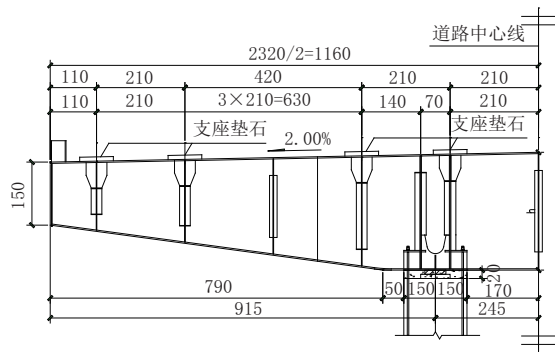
钢与混凝土复合结构桥墩立面图(单位:cm)
